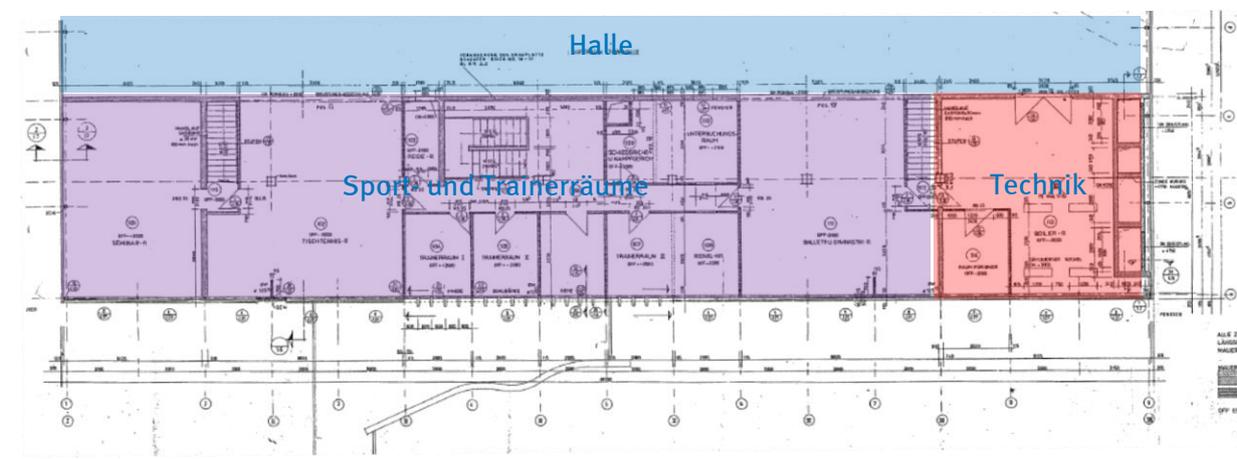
Grundriss TH 20 - Typ GT 75 L (Quelle: ZGM)
